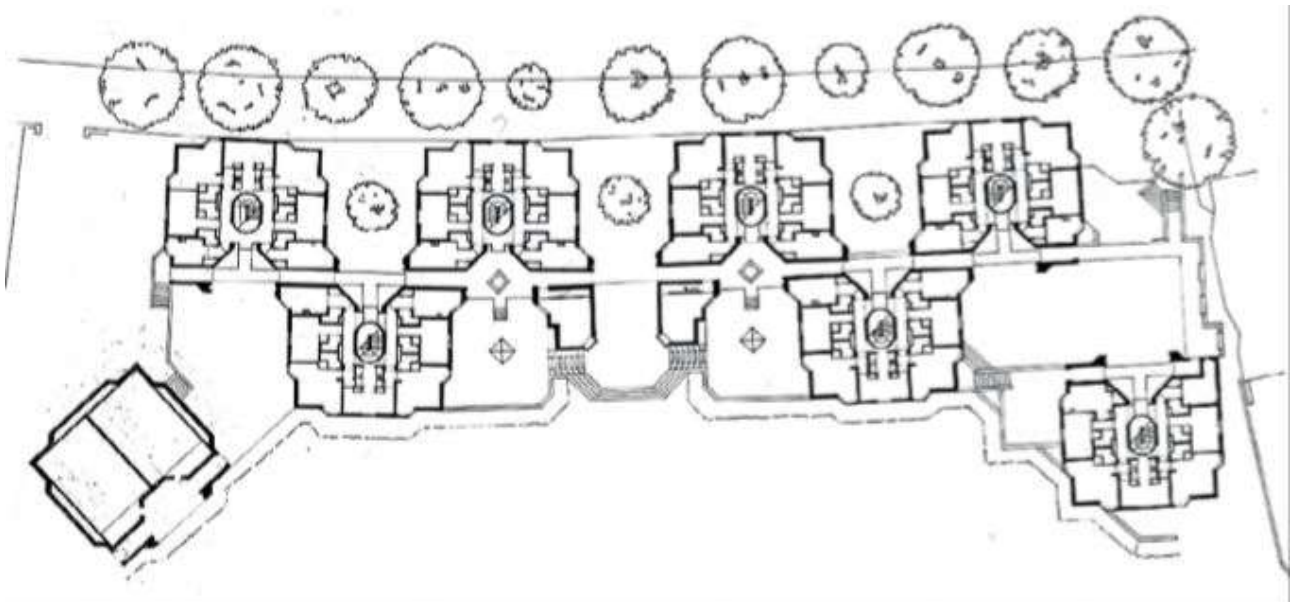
Implantação do Primeiro Pavimento. Balliol College, Reino Unido.
